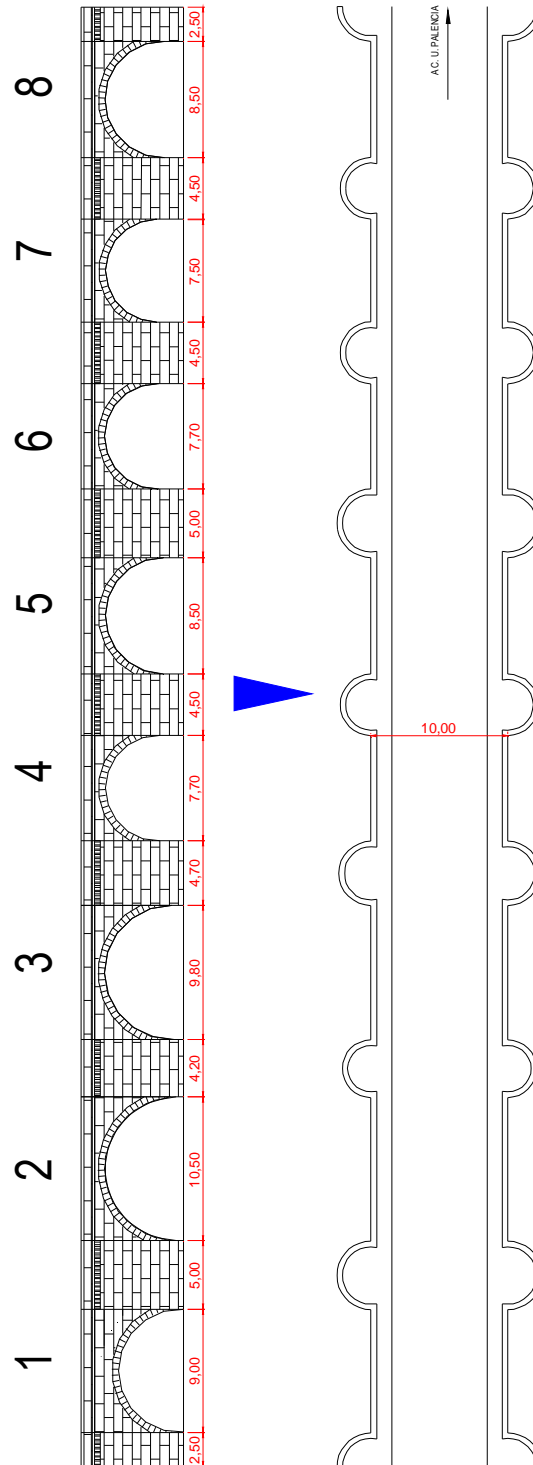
Dibujo de planta y alzado del puente Mayor.
